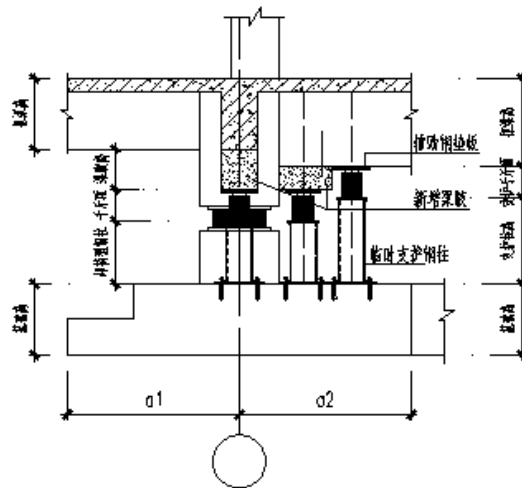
柱节点顶升荷载、支护钢柱安装平面图2
